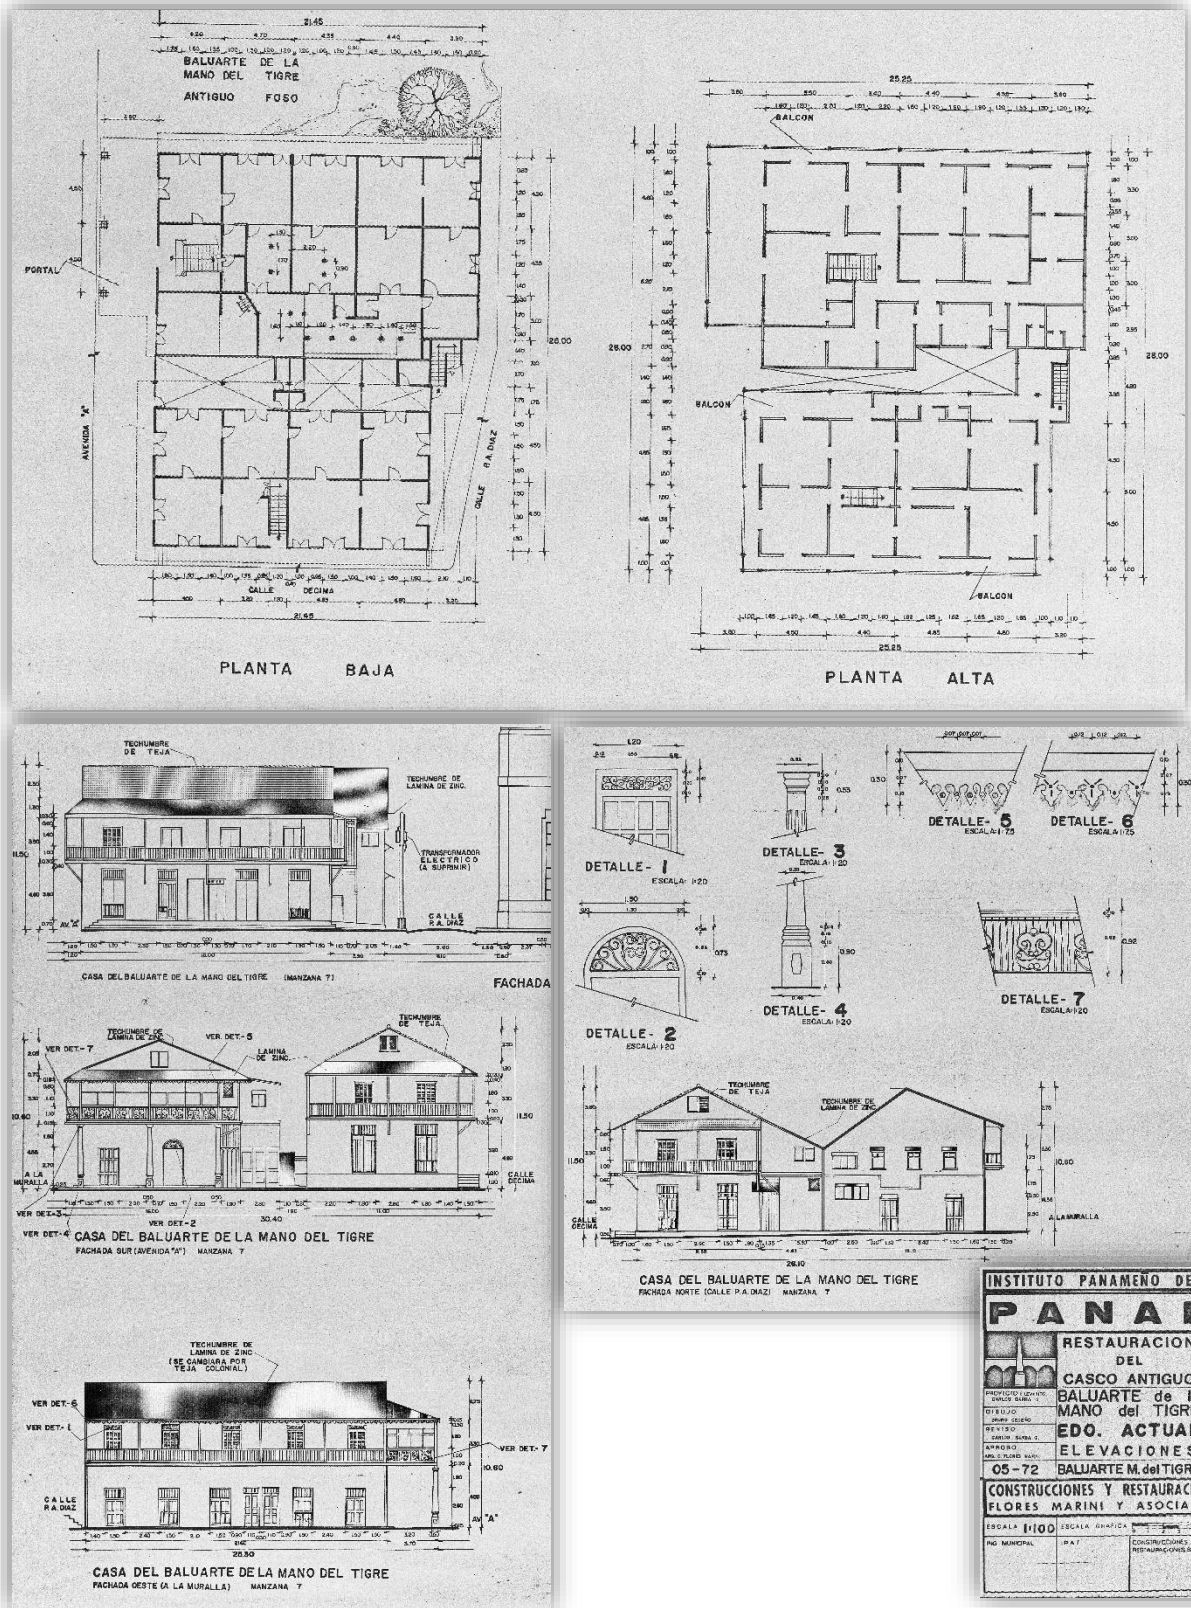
planos del levantamiento de las casas 1 y 2. (Flores Marini, 1975)
